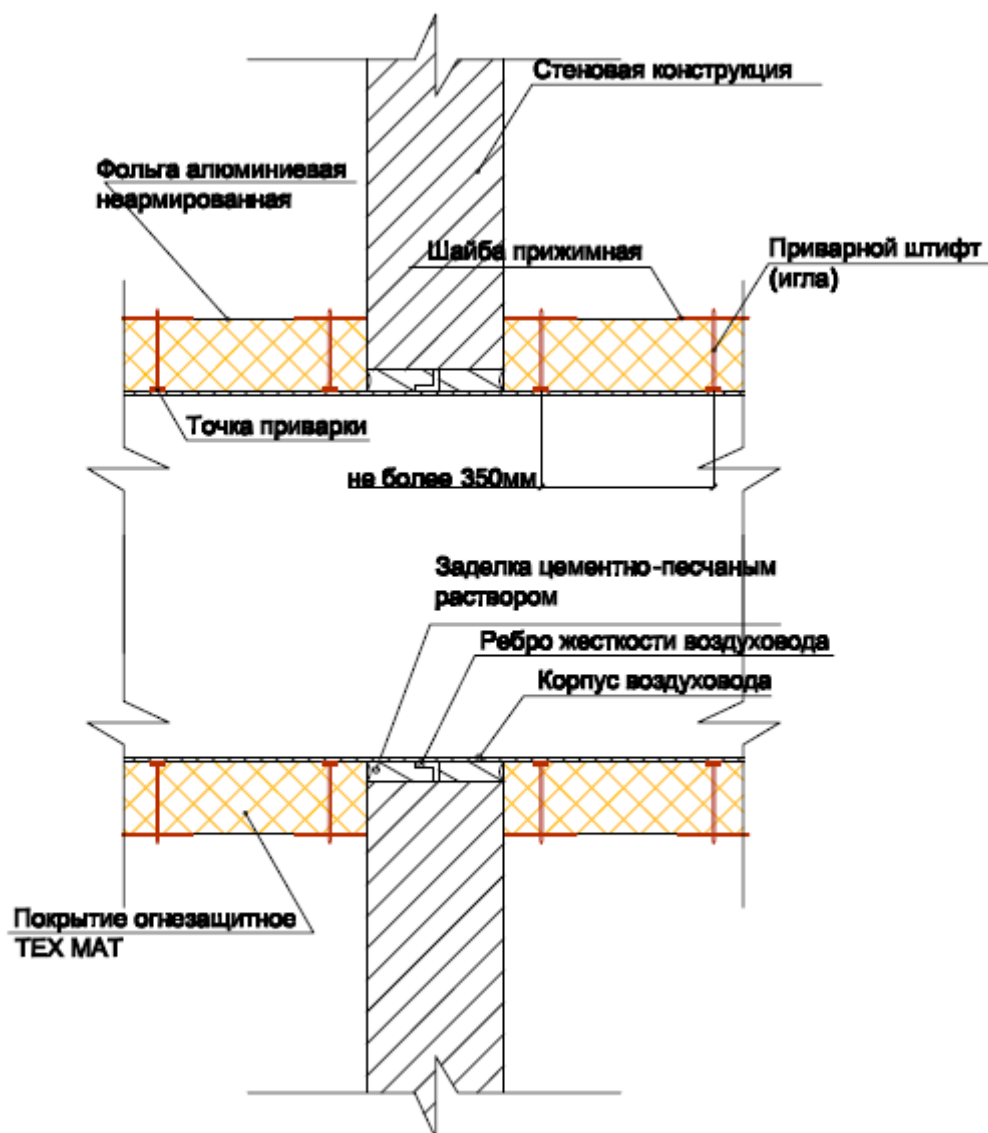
Принципиальная схема пересечения воздуховодом строительной конструкции.
